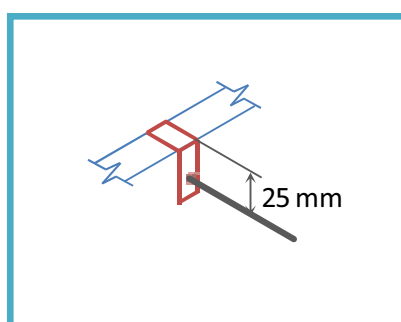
Detalhe da fixação da armadura na cantoneira.
